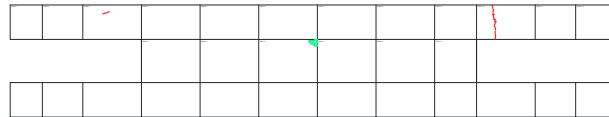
耐力壁および直交壁のひび割れ推移 -1/100 ①
